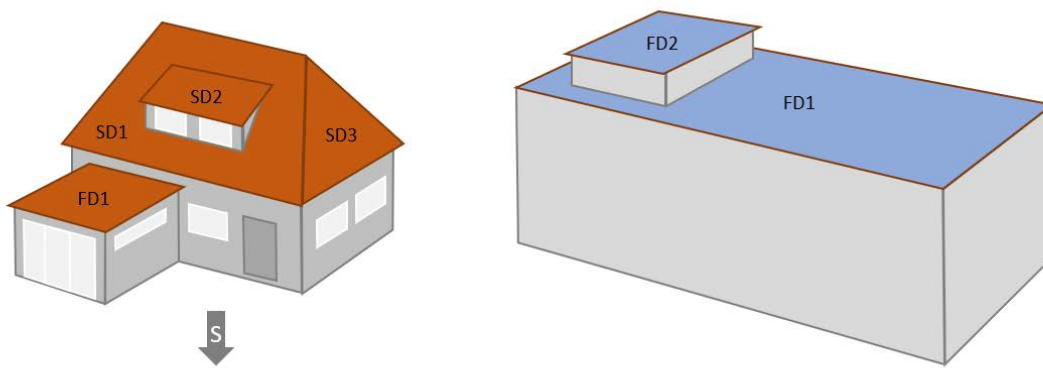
Einzeldachflächen Steildach (SD) in südliche Richtungen und Flachdach oder flach geneigtes Dach (FD) auf einem Gebäude mit Walmdach und Anbau (links) und einem Gebäude mit Flachdach und Aufbau (rechts)
